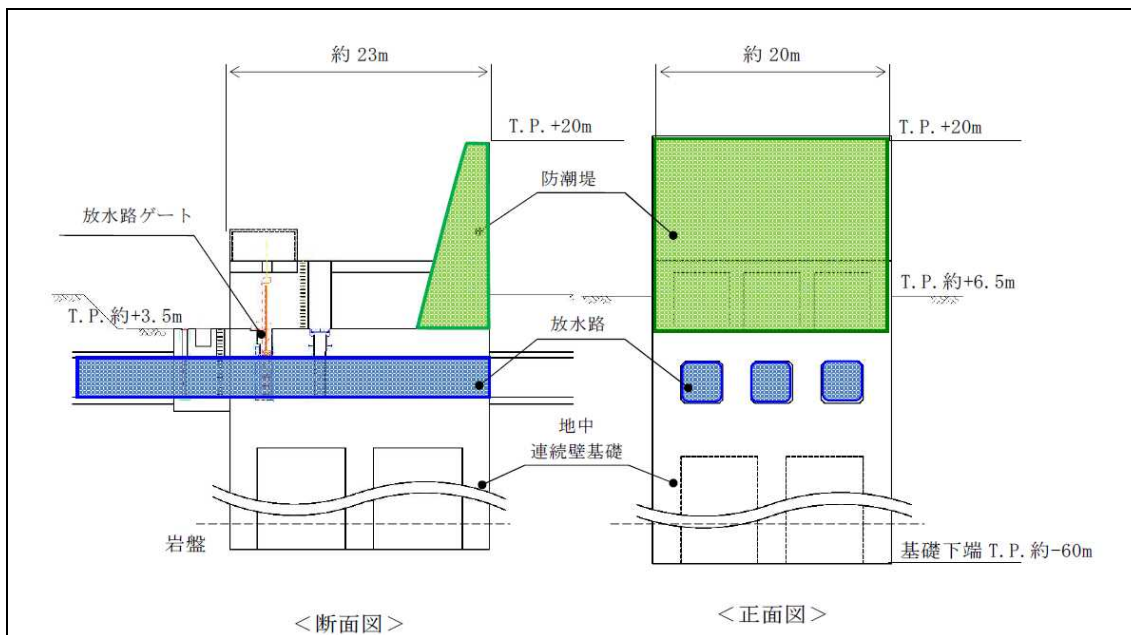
鉄筋コンクリート防潮堤の構造図（放水路エリア）（原電 東海第二）
